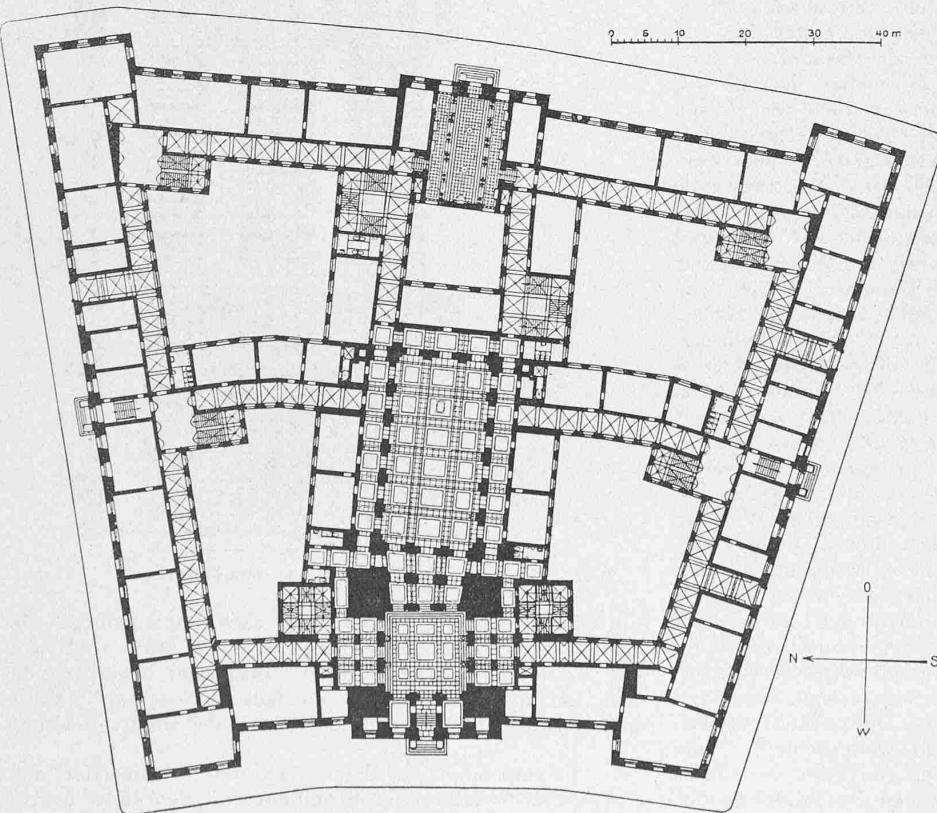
Neues Stadthaus in Berlin. — Erdgeschoss-Grundriss. — Maßstab 1:1000.
